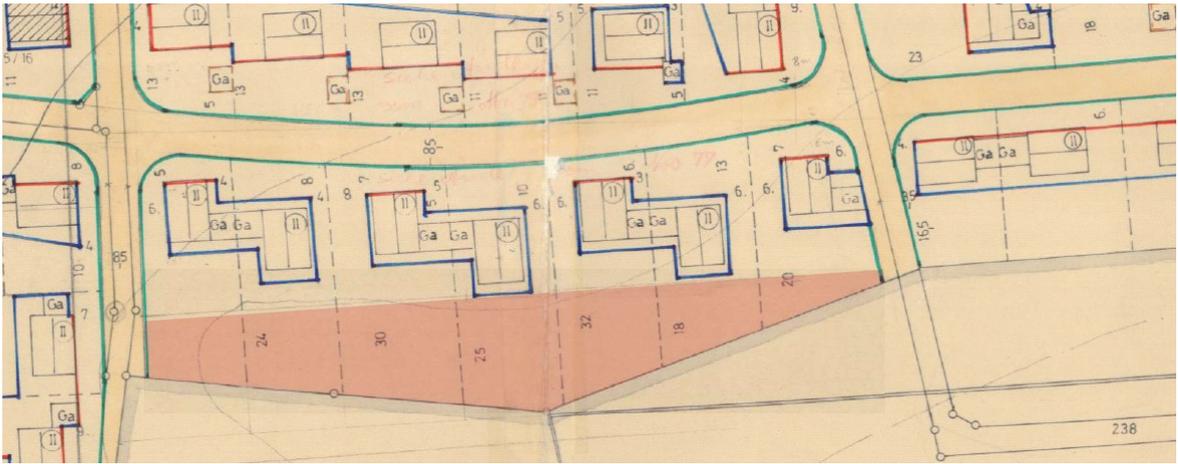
Ausschnitt a.d. rechtskräftigen Bebauungsplan „Odelzhausen Süd“ mit Darstellung des Überschreibungsbereiches in blass-rot, o.M.
